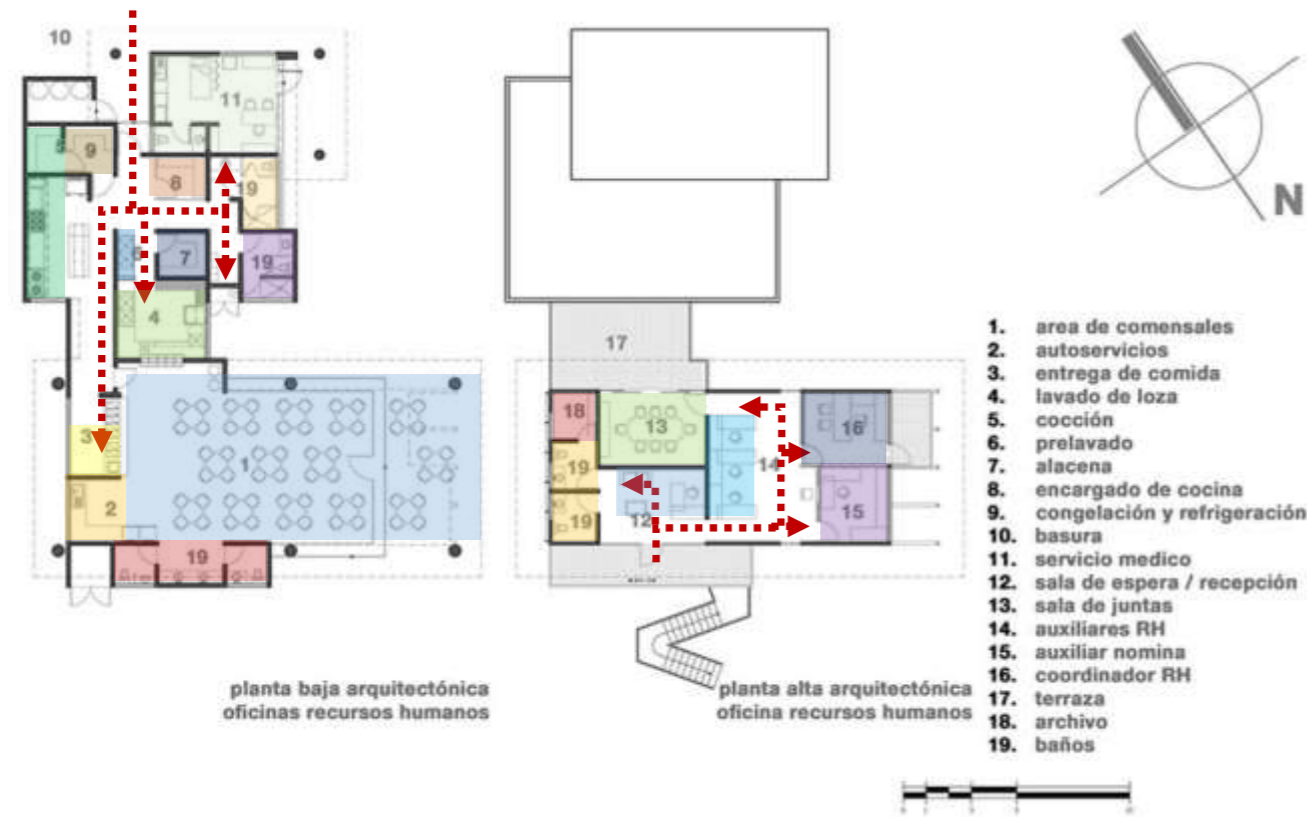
Planta arquitectónica Planta liofilizadora de café
